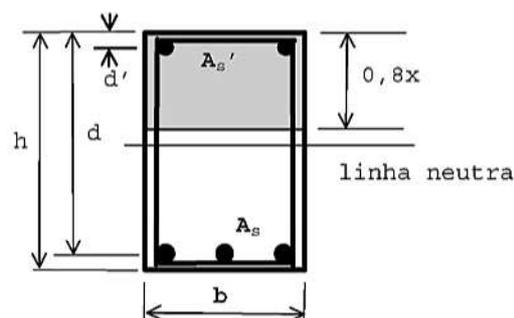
Esquema das dimensões usuais em vigas retangulares de concreto armado.
